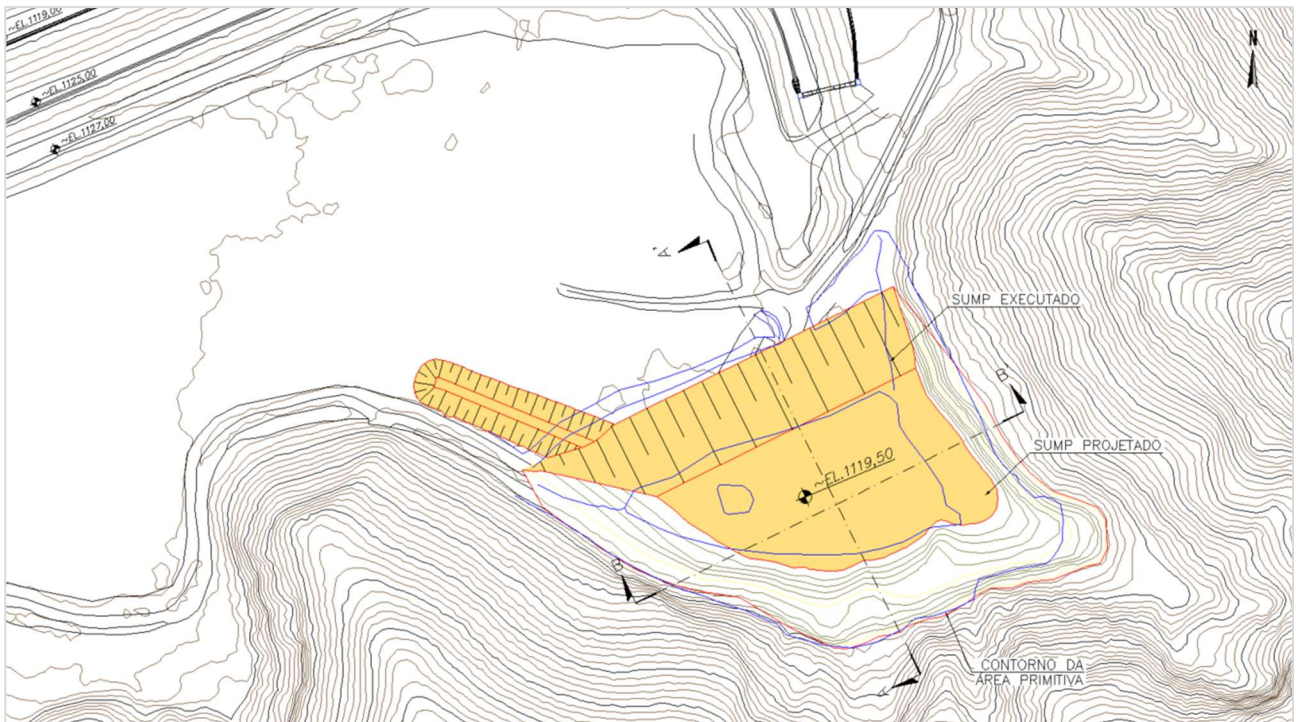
Comparativo Projeto x Executado - Planta (Sump)– Fase 1A.
